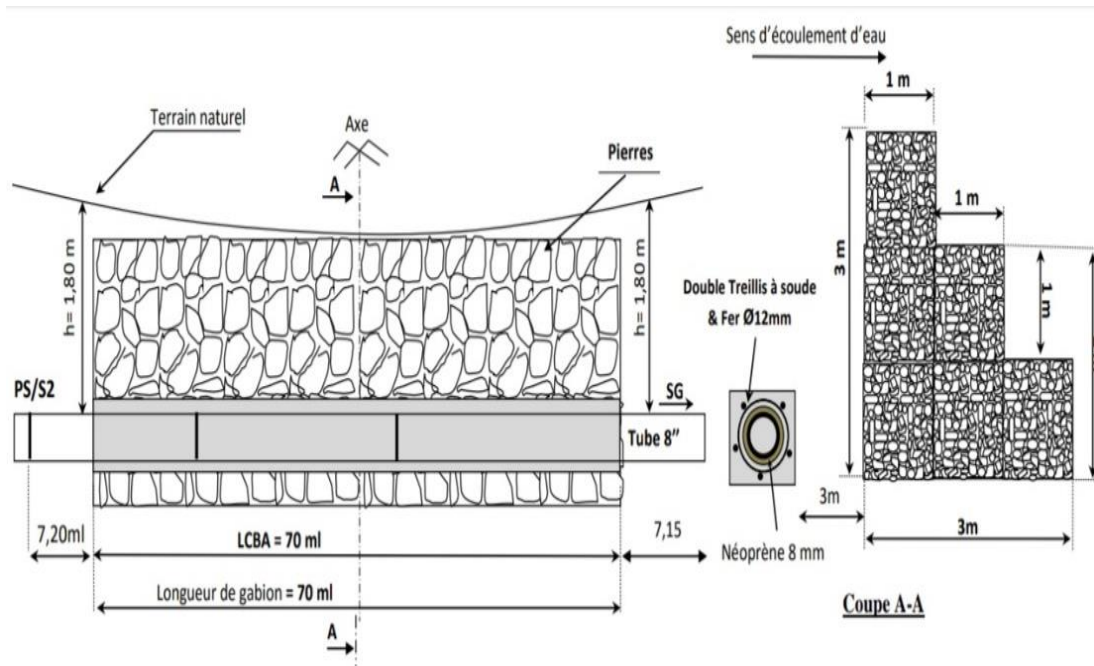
Croquis de listage et gabionnage de traversée d'oued el-Kabir (PK : 2+267.00).
